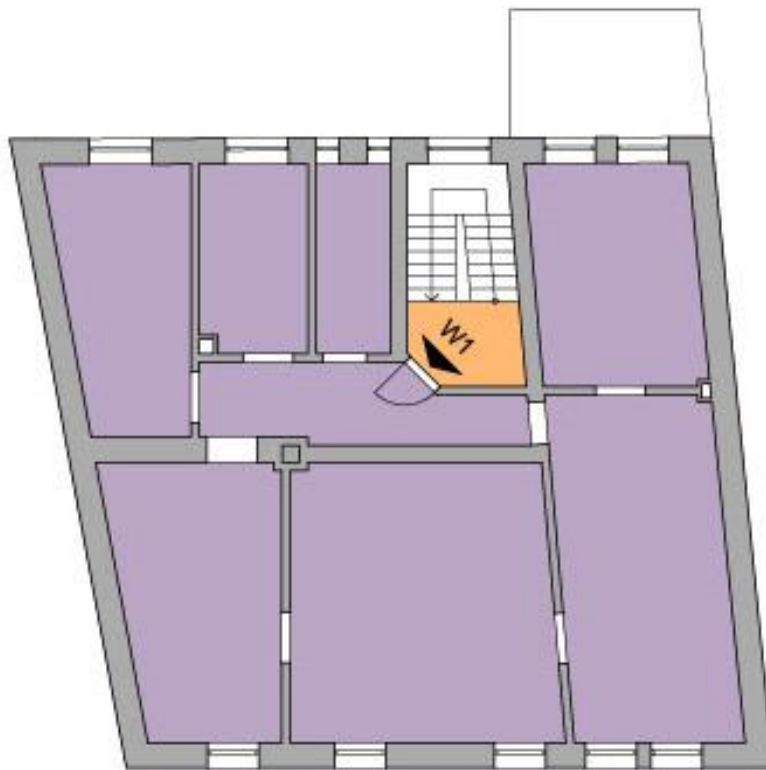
Grundrissdarstellung 1. Obergeschoss
